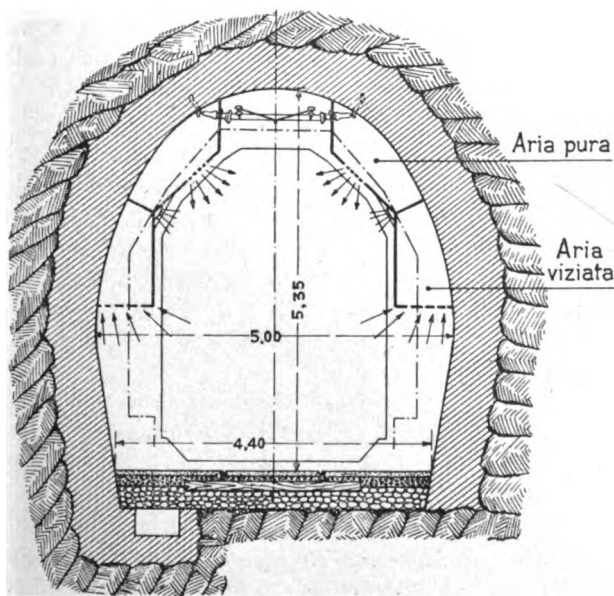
Sezione trasversale della galleria del Sempione con il progetto di condutture per ventilazione.
